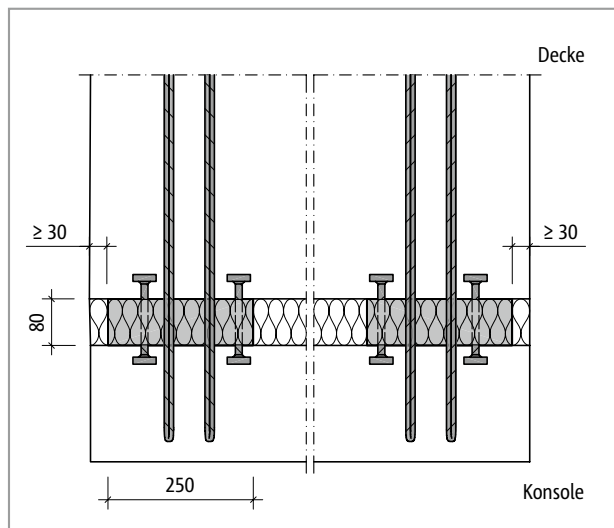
Schöck Isokorb® T Typ O: Einzuhaltender Randabstand
